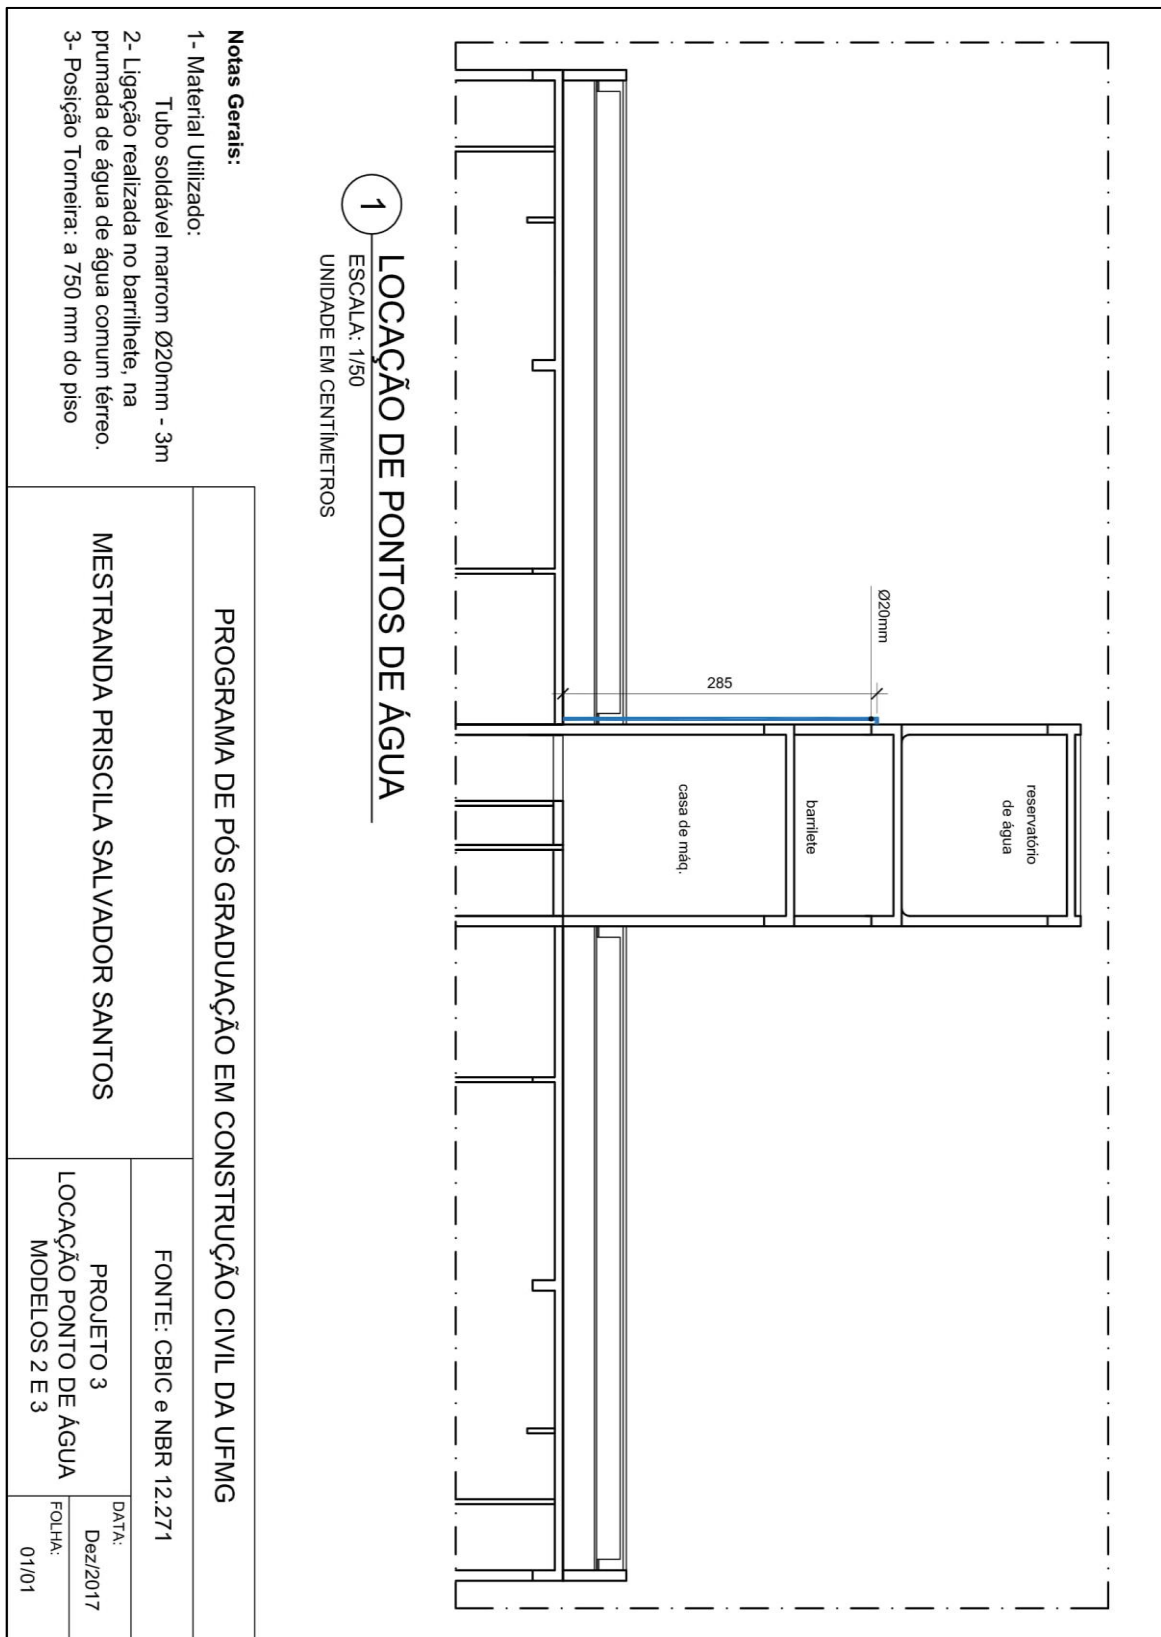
Planta localização Ponto de água Projeto 2 do Modelo 2
